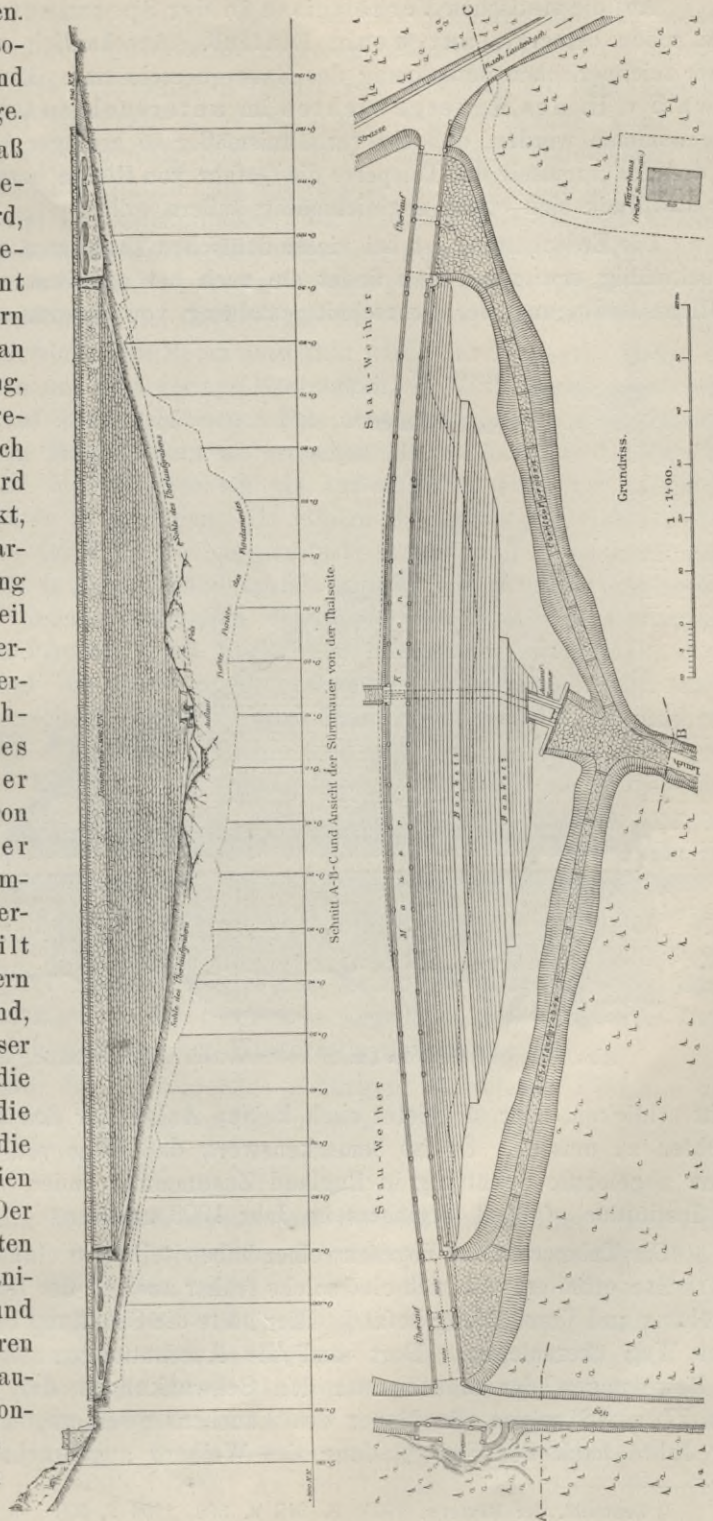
Ansicht und Grundriss des Lauchense-Stauweihers.
